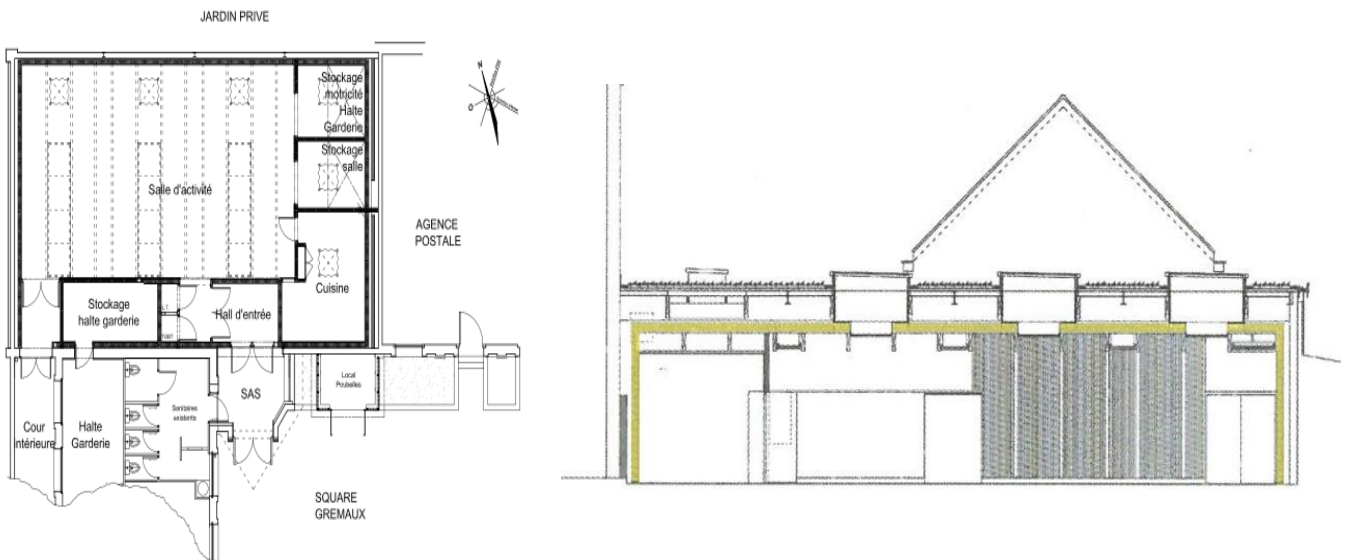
Plan de la salle [43] et coupe longitudinale du bâtiment [30]
